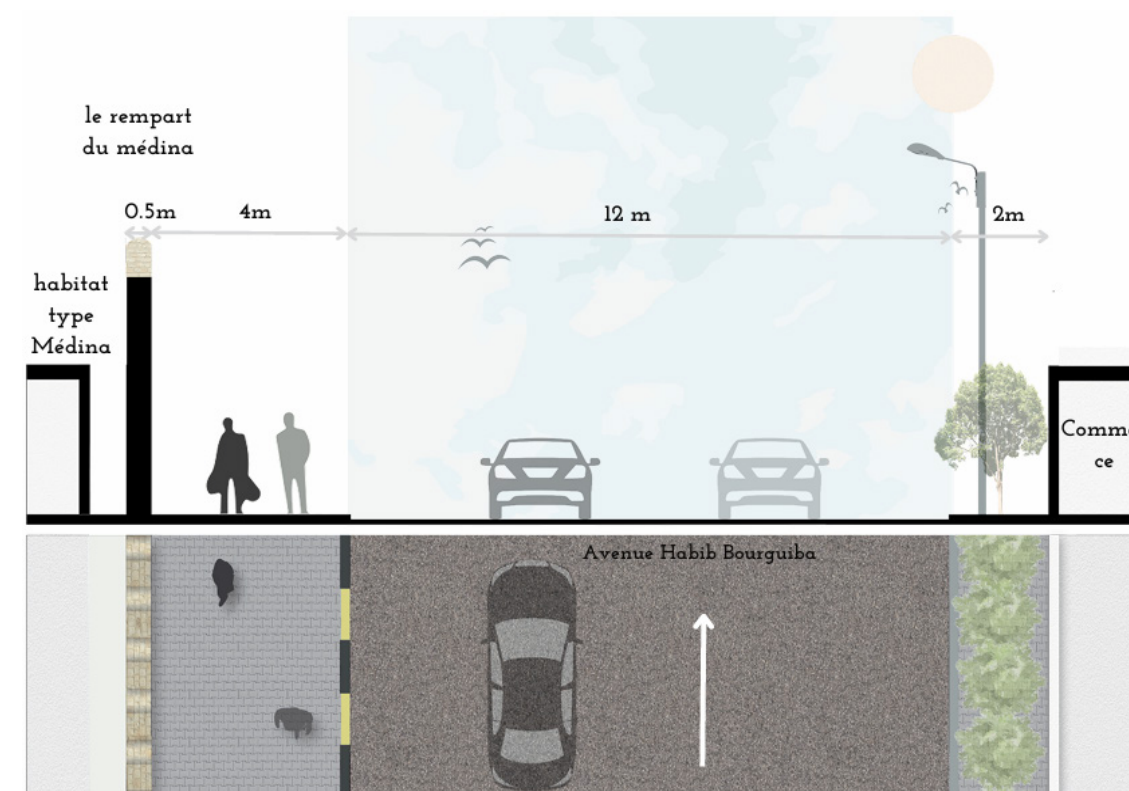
Étude plus approfondie sur la zone du marché _ coupe sur voie
